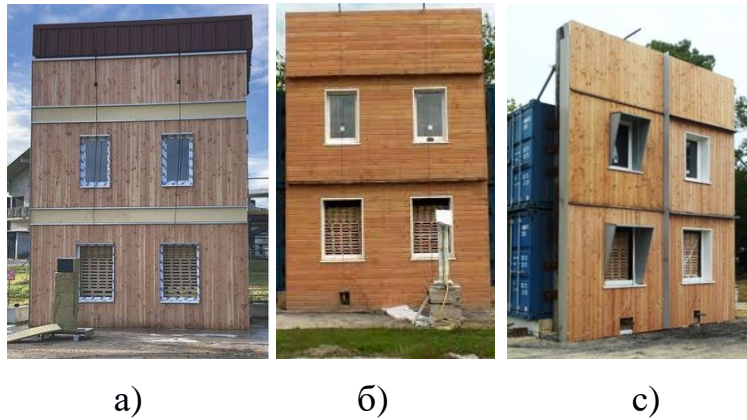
Приклади фасадних систем обладнаних фасадними протипожежними перешкодами за методикою LEPiR2, де: а) фасадна система обладнана протипожежним поясом; б) фасадна система обладна протипожежним карнизом; с) фасадна система обладнана протипожежними віконними карнизами та вертикальним протипожежним перешкоджувачем.
